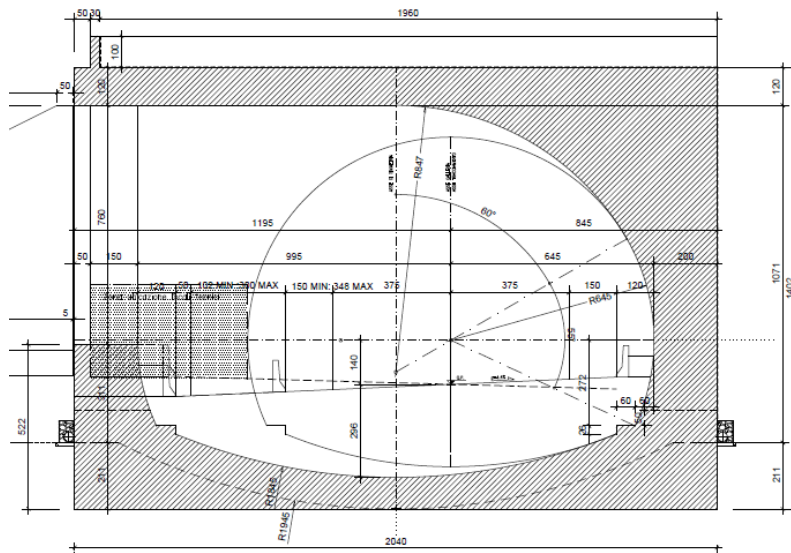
SEZIONE TRASVERSALE GALLERIA ARTIFICIALE FINESTRATA
